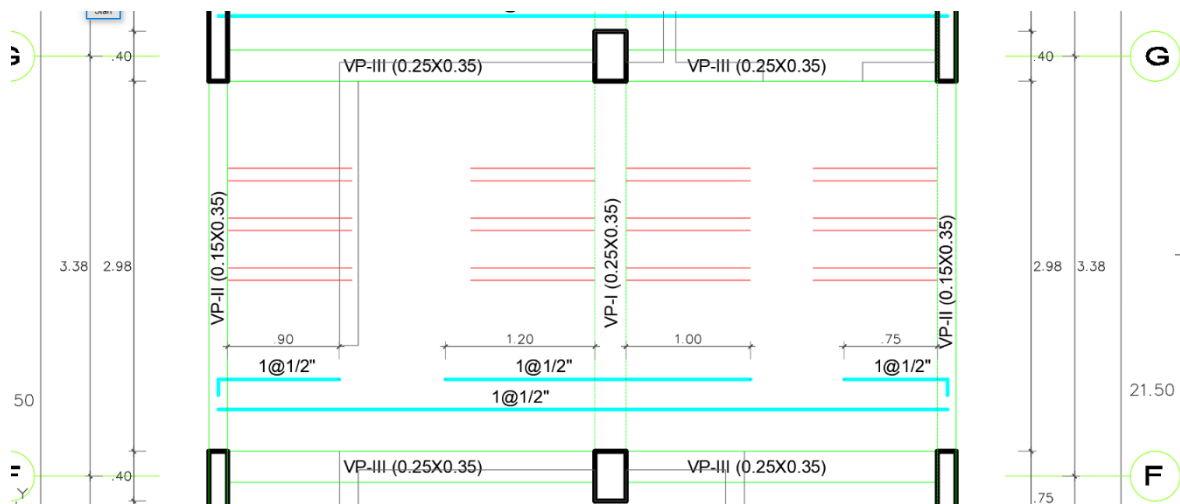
Refuerzo de losas aligeradas en una dirección paños continuos.
